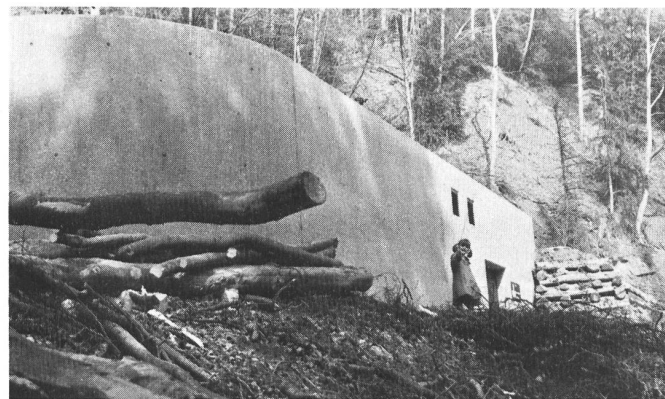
Reservoir Ris (1981), fertigerstellte Anlagen mit braungefärbter, gestockter Sichtbeton-Fassade.
